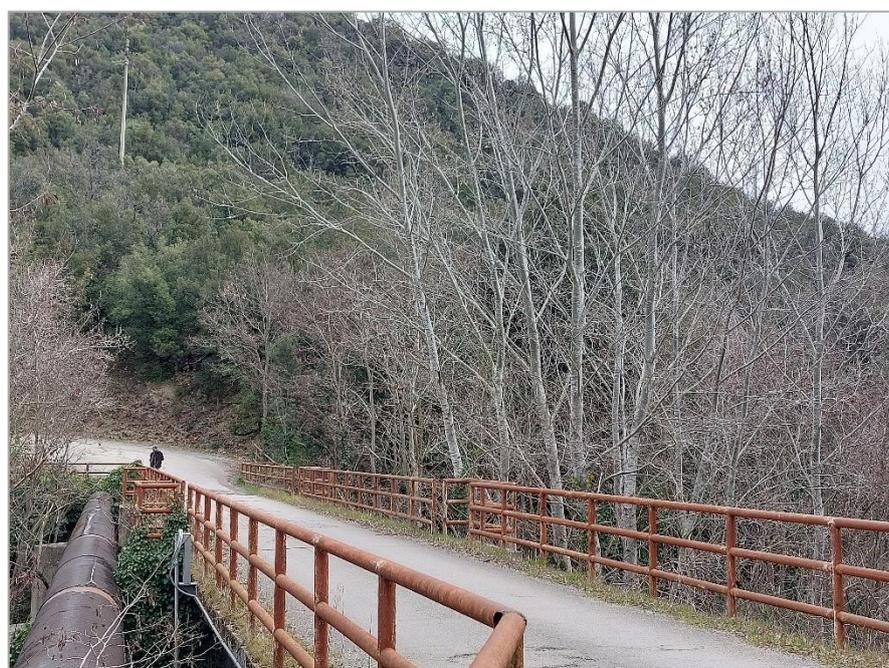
20220317_115635: vista della condotta esistente parallela al ponte stradale (non oggetto di intervento). La nuova condotta attraverserà l'Aventino in aderenza al ponte esistente, sul lato di monte dello stesso.
